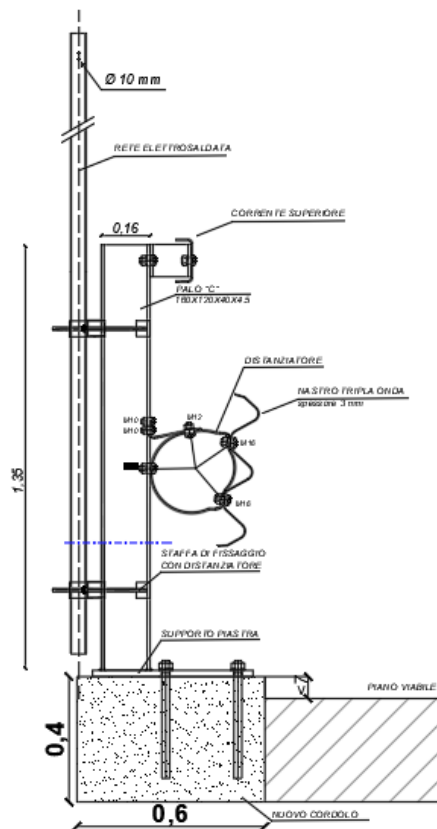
Sezione impalcato con evidenza dell'intervento di ricostruzione
